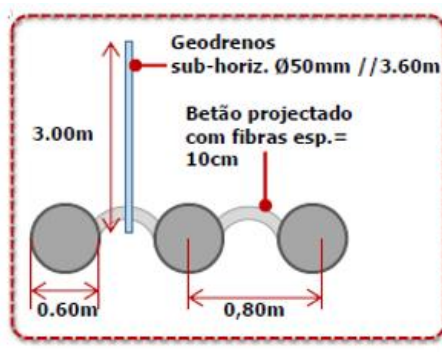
Planta do pormenor tipo de drenagem da cortina [26].
